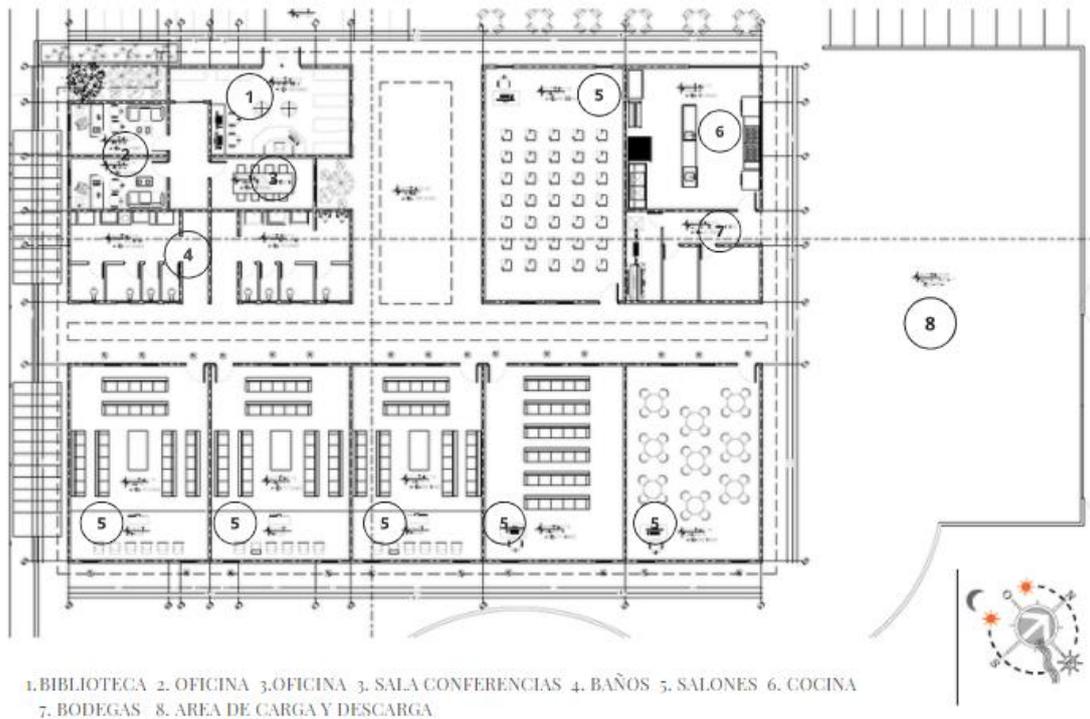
Planta arquitectónica de zona de aprendizaje
